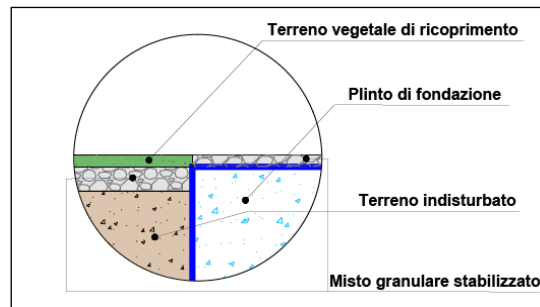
Particolare pavimentazione piazzola tipo in fase di esercizio
